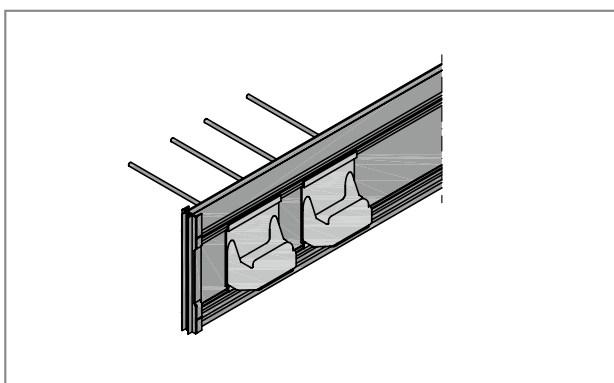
Schöck Tronsole® Typ T : Detail Tragkonsole positive Fertigung
